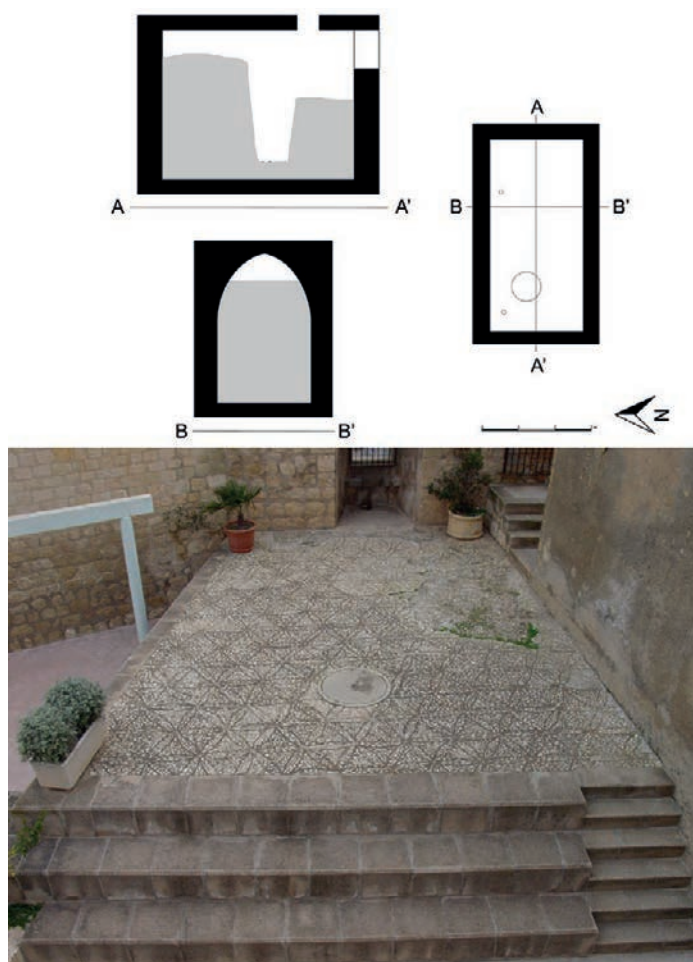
Vista de la parte superior del aljibe III con su planta y secciones (Archivo Museo Dámaso Navarro).
